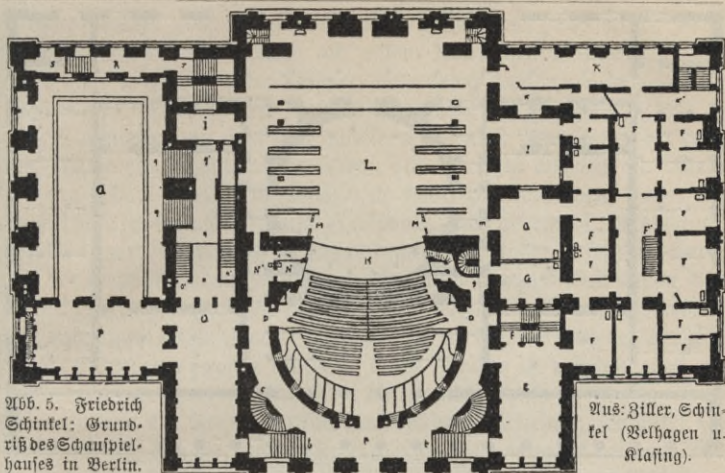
Friedrich Schinkel: Grundriß des Schauspielhauses in Berlin.
